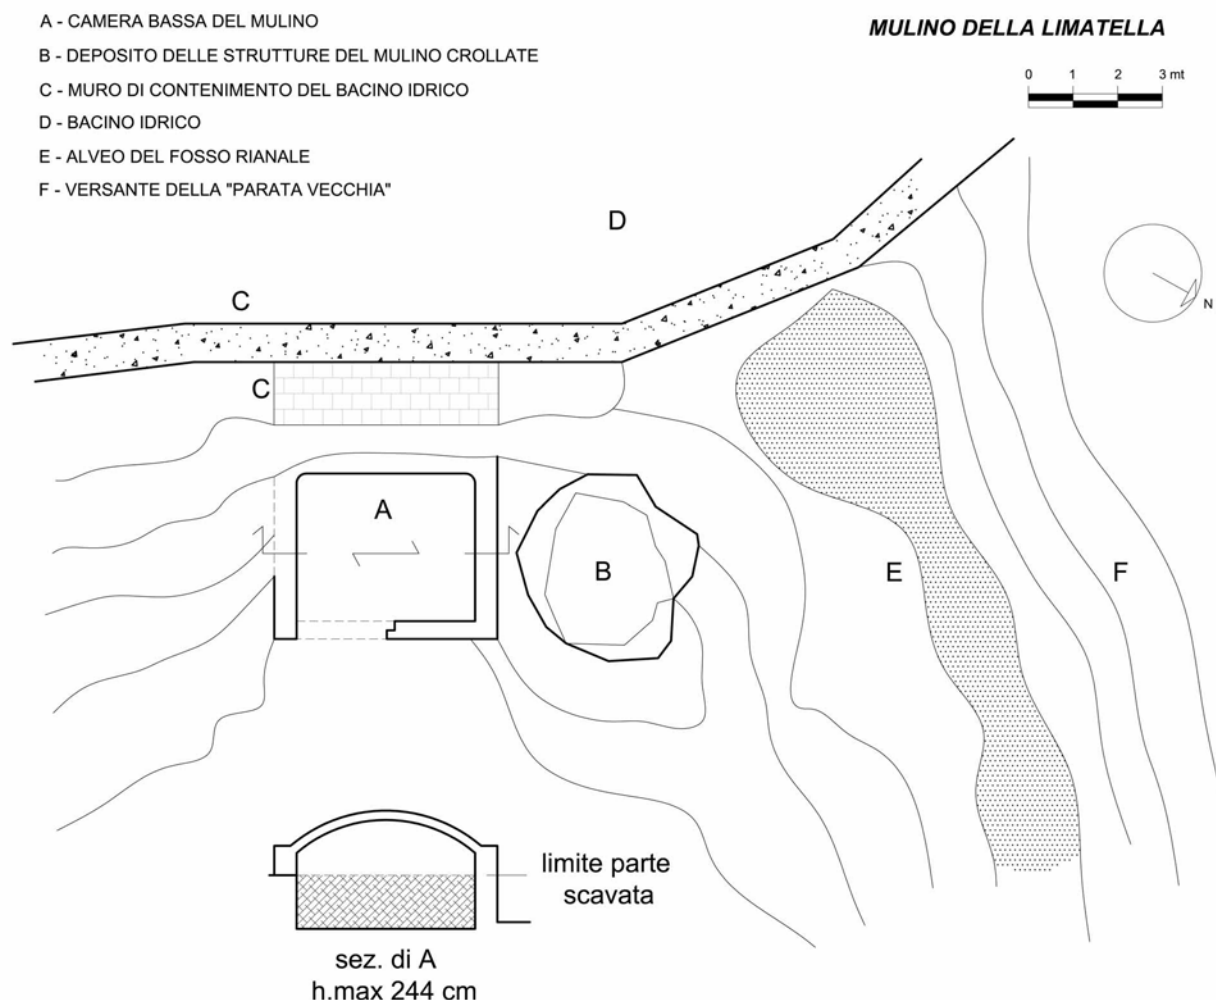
Mulino della Limatella. Schema planimetrico (elaborazione dell'Autore).
